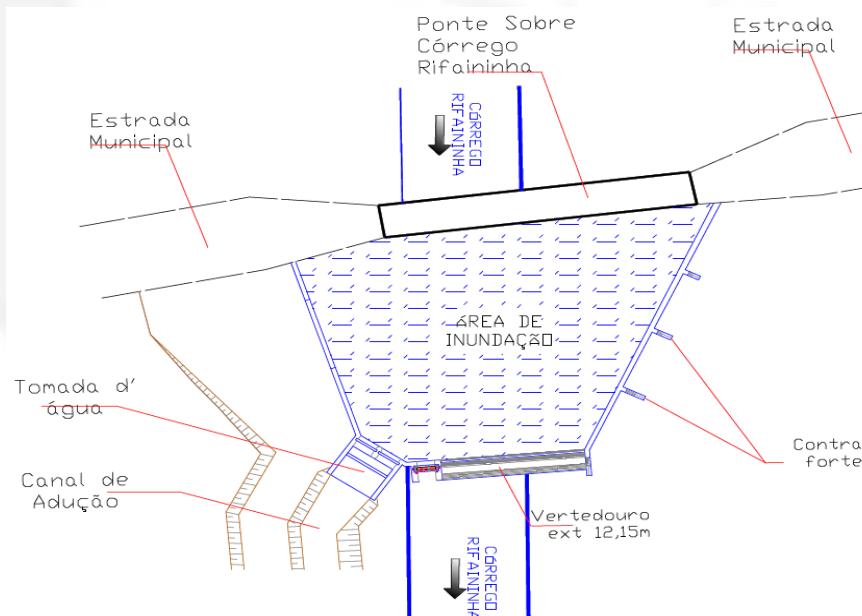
Layout da área de inundação, tomada d'água e canal de adução
